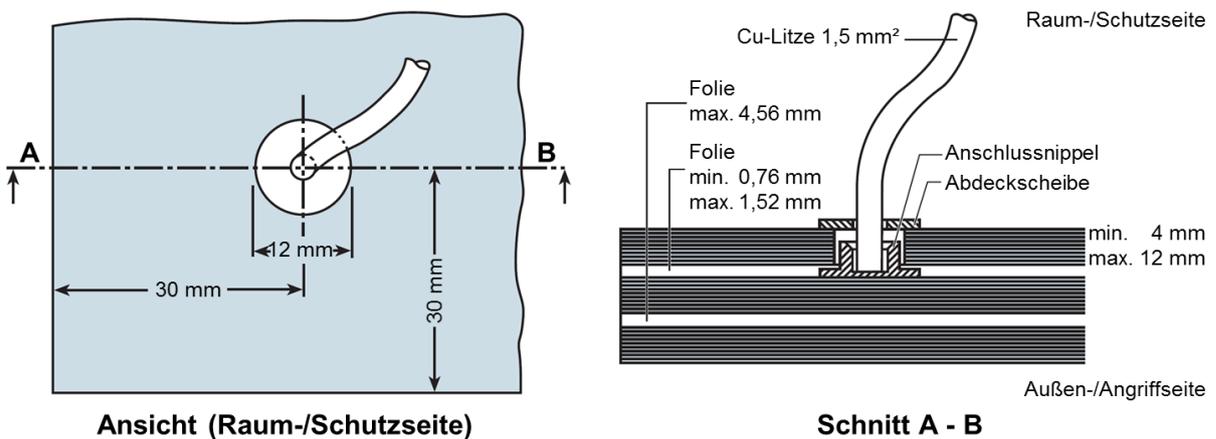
SIGLA® Alarmglas mit Flächenanschluss (Beispiel für 3-schichtigen Aufbau)
